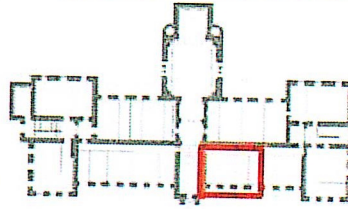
План первого этажа с указанием помещений. Оформление потолка
